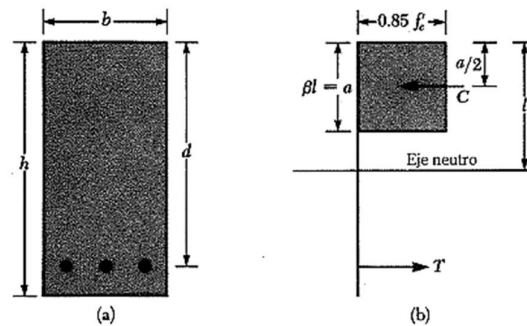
Sección rectangular en flexión: Sección transversal y distribución del esfuerzo en la sección.
